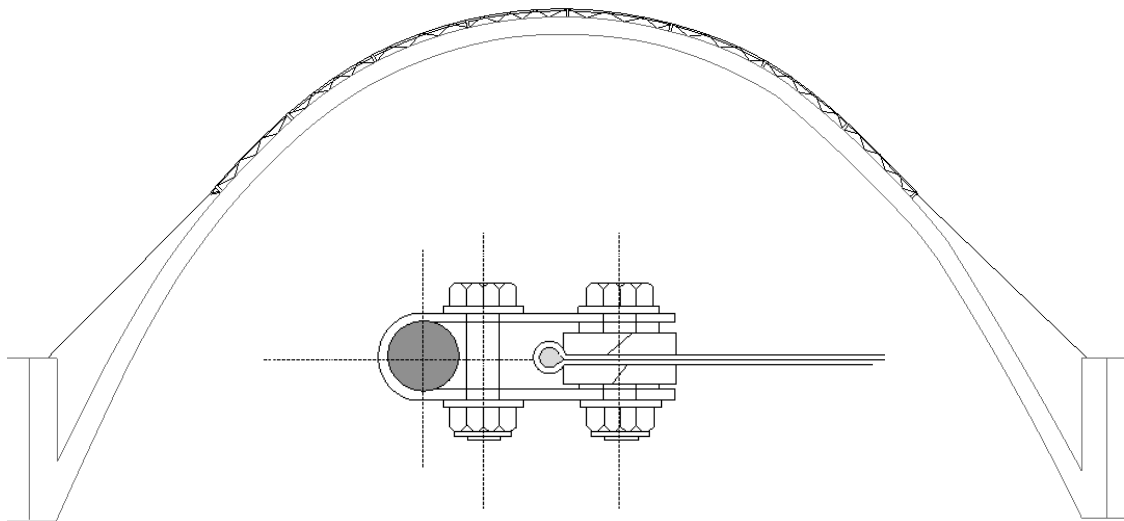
Tenso estructura aplicada al arco, detalle de union .
